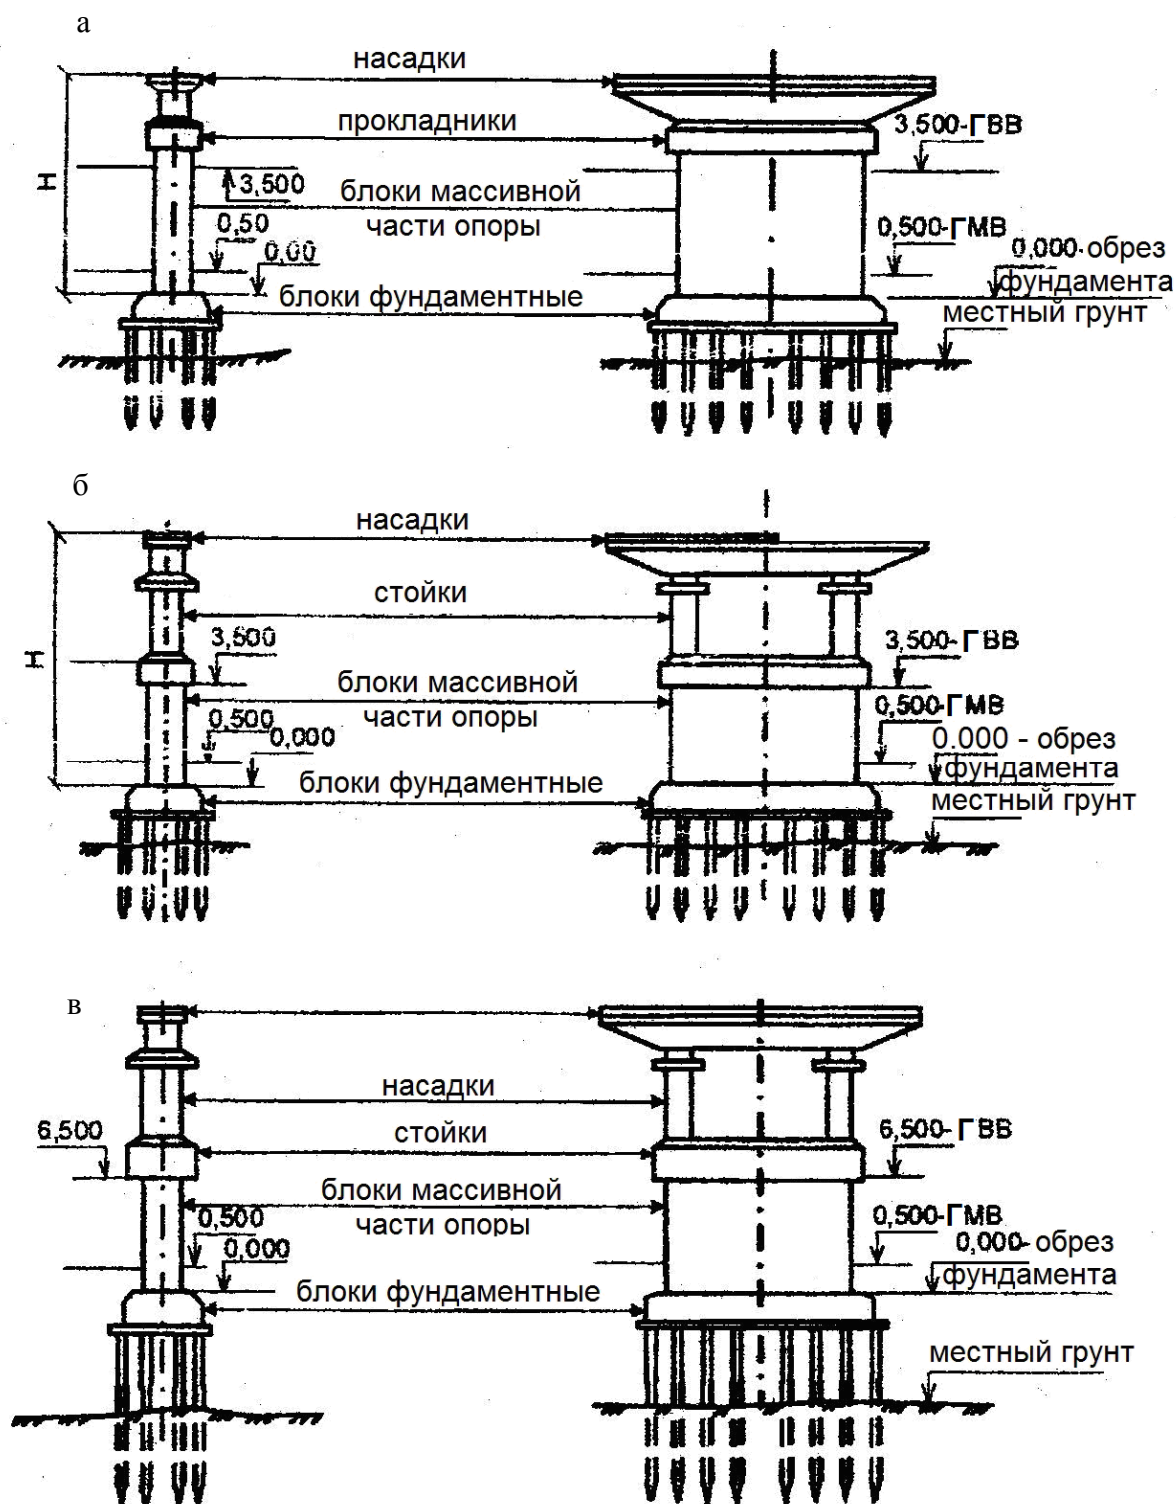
Схемы опор на фундаментах из свай: а – при  $H = 5-7$  м (с массивной надстройкой); б – при  $H = 9$  м (со столбовой надстройкой) в – при  $H = 11-13$  м (со столбовой надстройкой)
